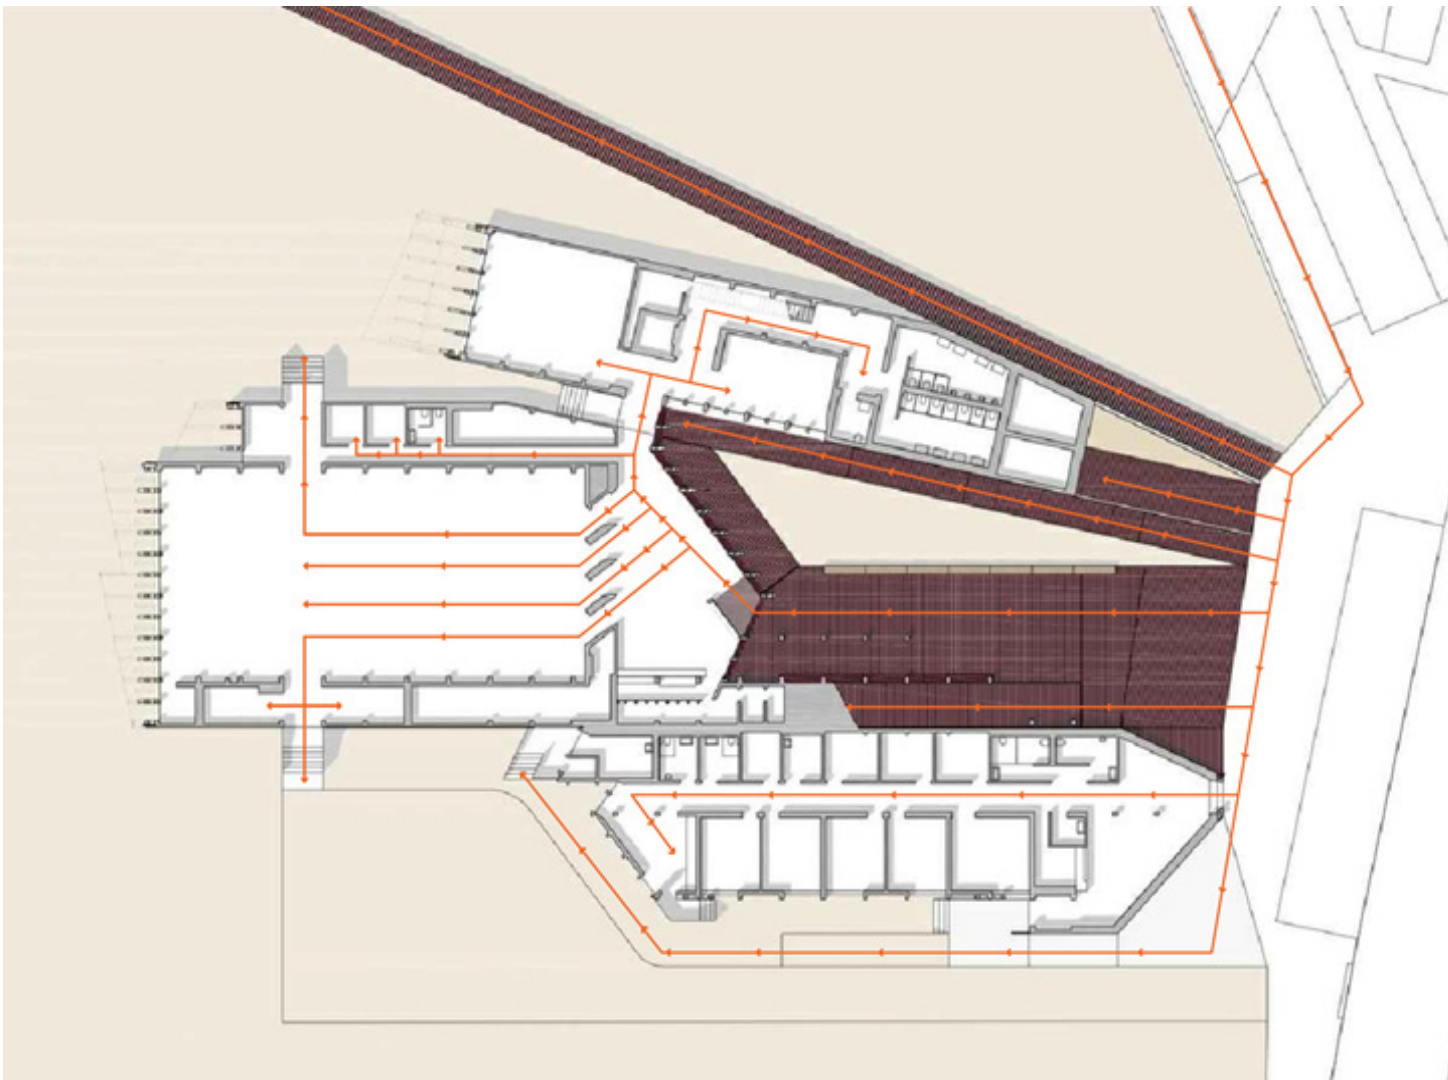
Planta Arquitectónica del proyecto. Fuente: ARX Portugal 2015
